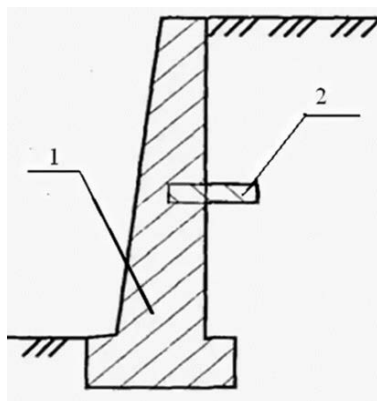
Подпорная стенка с разгрузочной площадкой:
